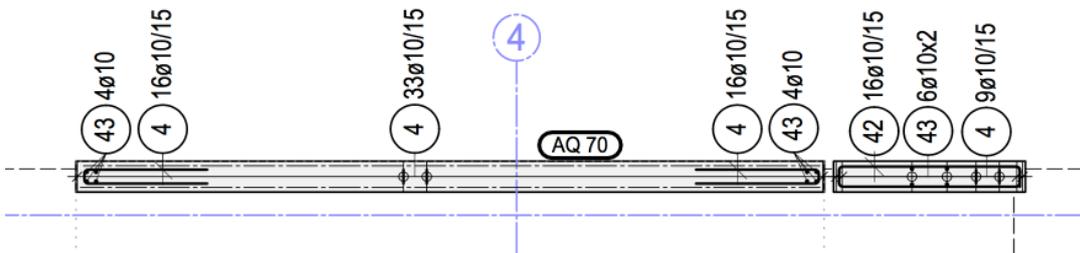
Bewehrungsplan Grundriss der Musterfläche 1
